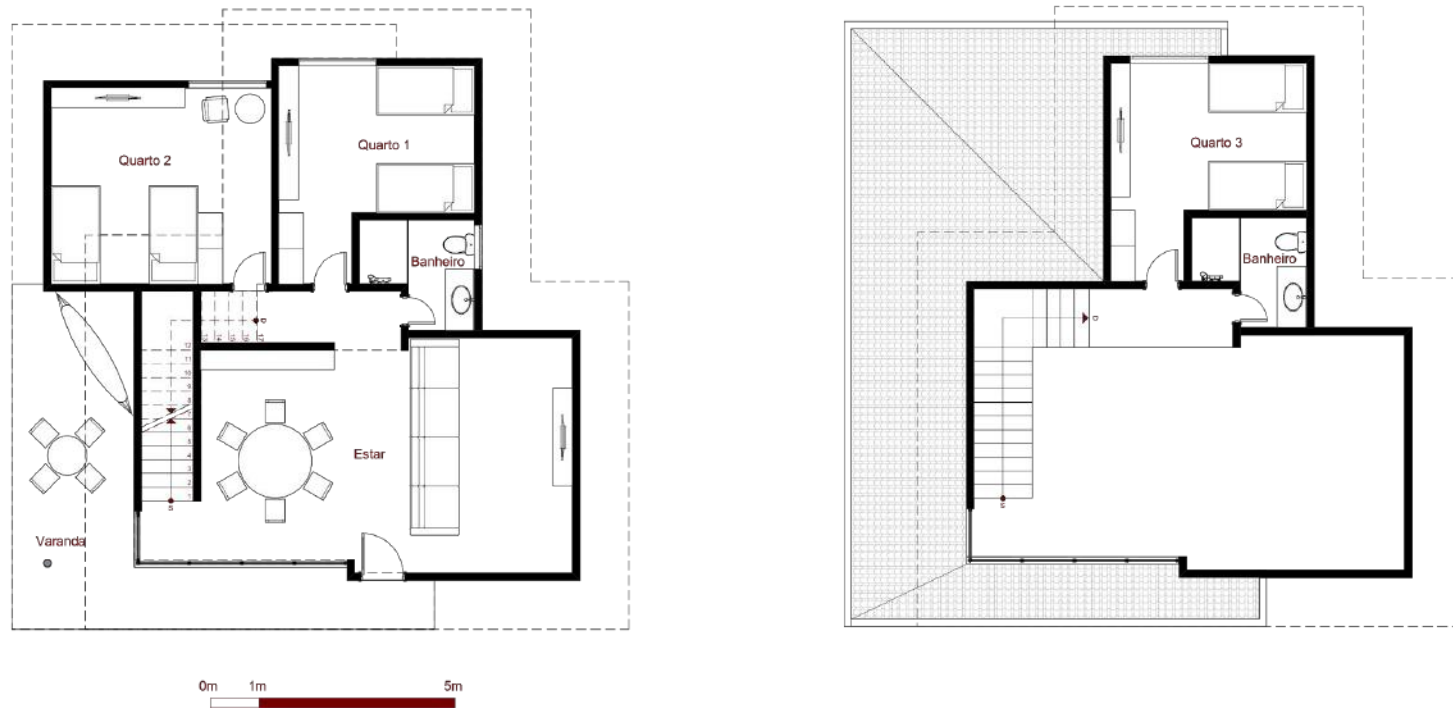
Planta baixa cabana de 3 quartos térreo (esq.) e primeiro pavimento (dir.).
